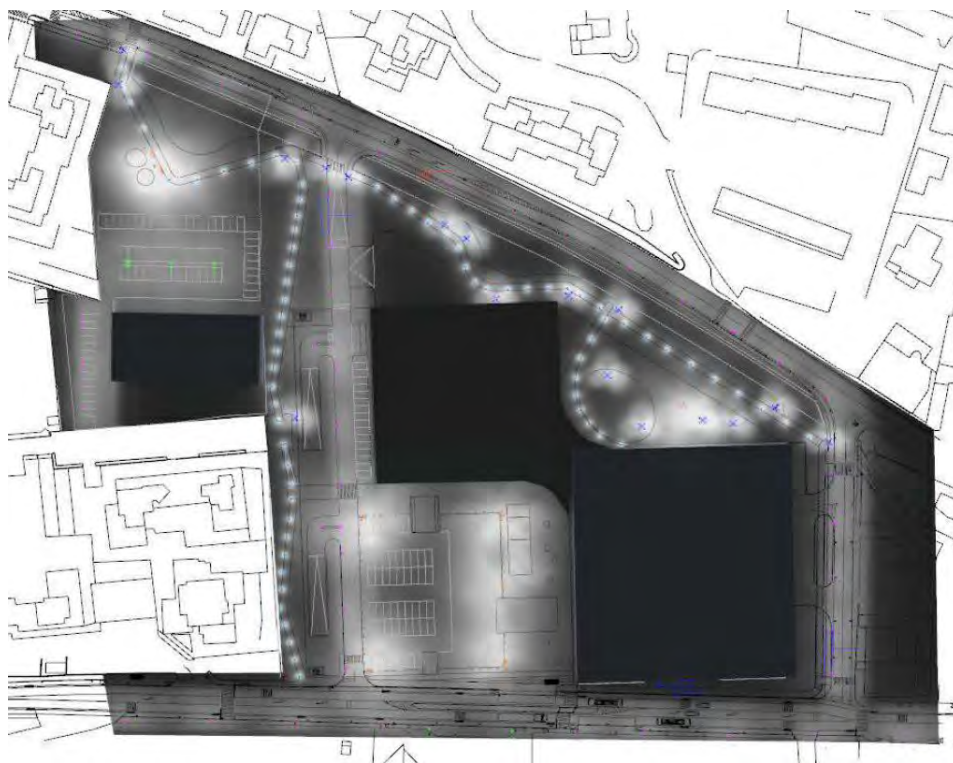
Estratto della planimetria di progetto "Planimetria Illuminazione Pubblica e Verifiche Illuminotecniche". Elaborato allegato al PII.
